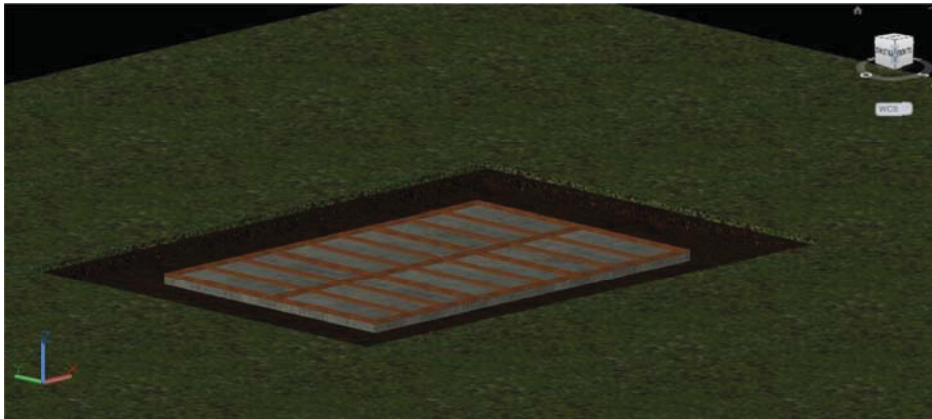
Posa dell'orditura reticolare costituita da magatelli in legno.
